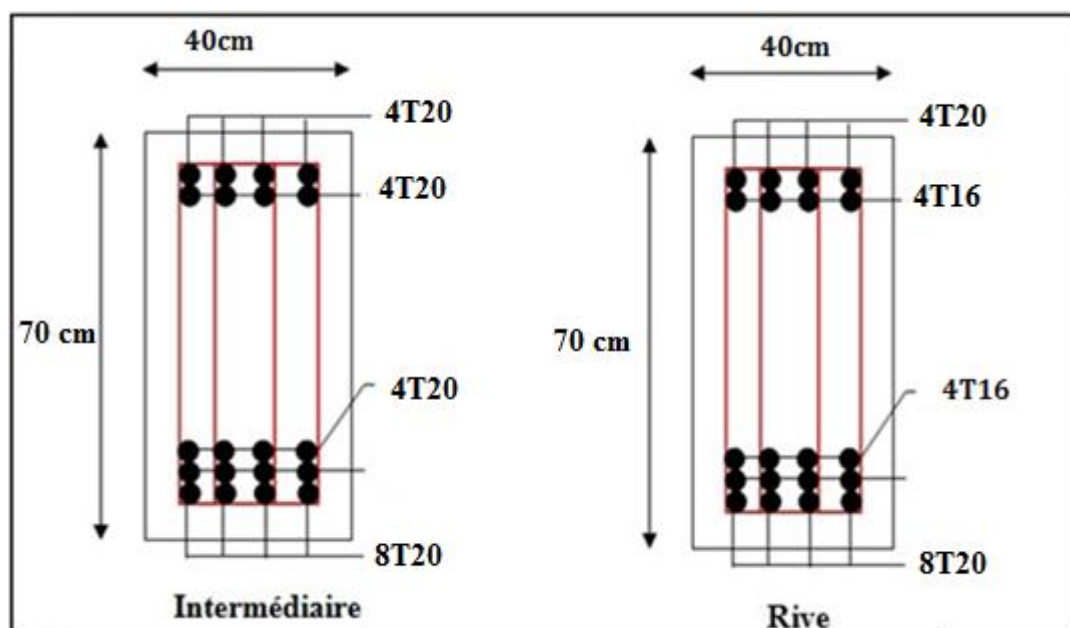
Ferrailage de la poutre de libage suivant le sens longitudinale.
